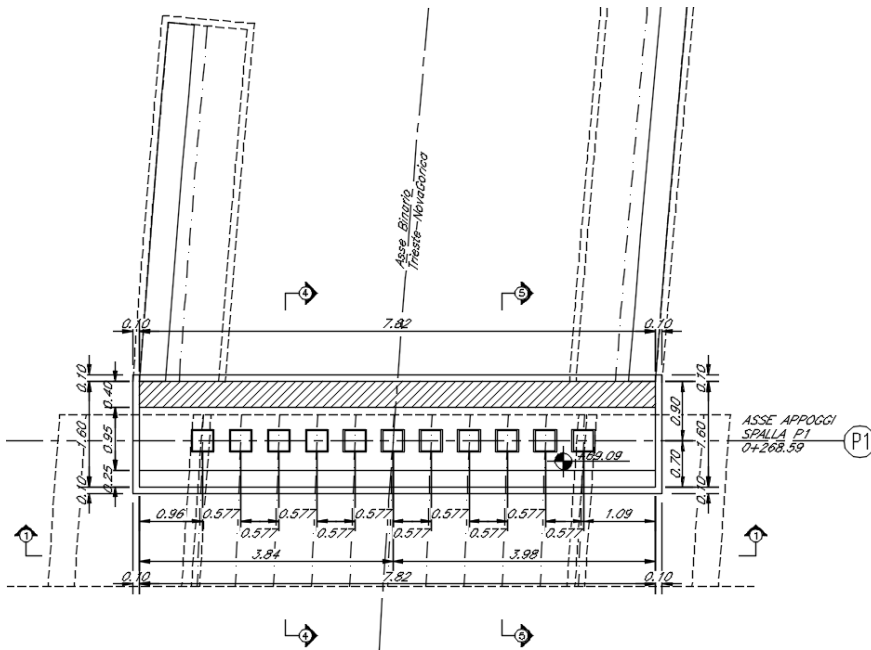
Spalla P1 - Sezione orizzontale 3-3 (sezione a quota appoggi)
